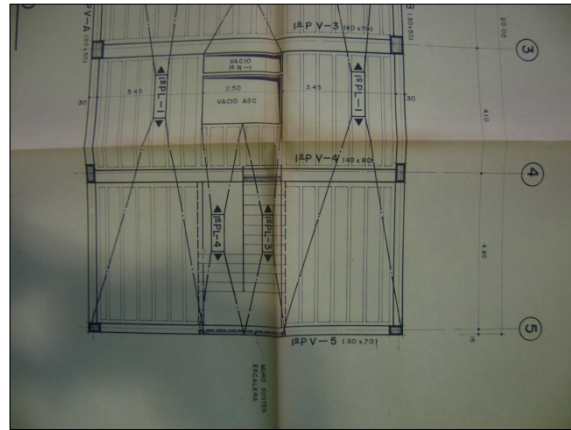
Fotografía de Plano de Estructura de Planta Tipo
